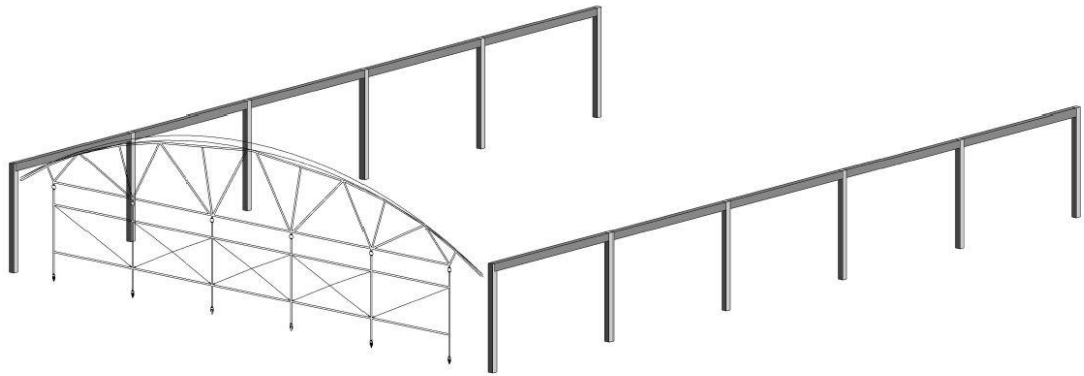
Proceso constructivo Fase 2 Fuente: Elaboración propia
